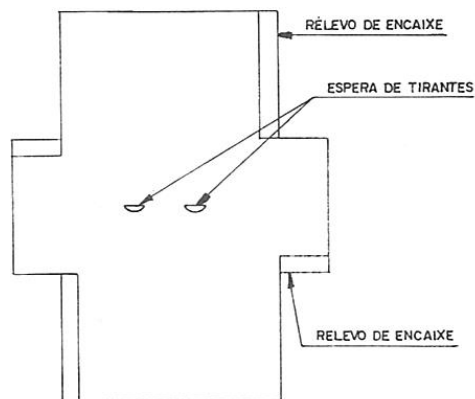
Trincheira Armada – Peças Pré-fabricadas.
